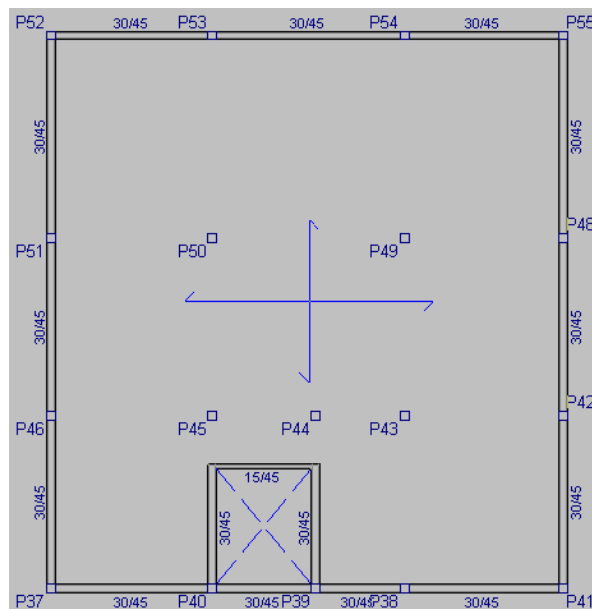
Representação da laje do segundo pavimento. (Fonte: Software CypeCad).
